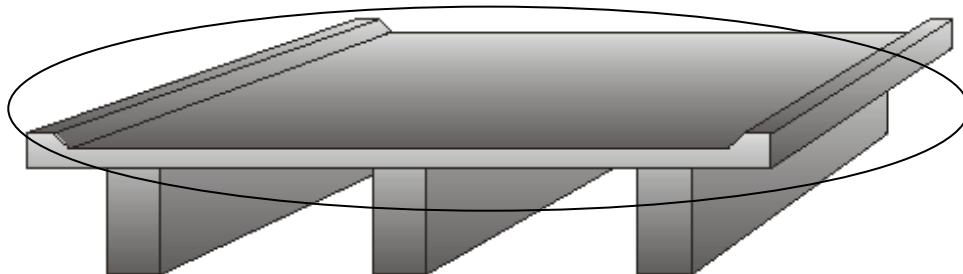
Posizione dell'Elemento Standard nella struttura (BRIME – D14).
